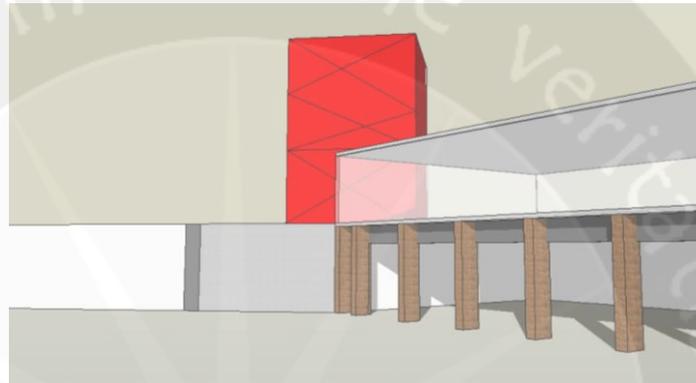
22 Contoh Aplikasi *Open Plan Layout
